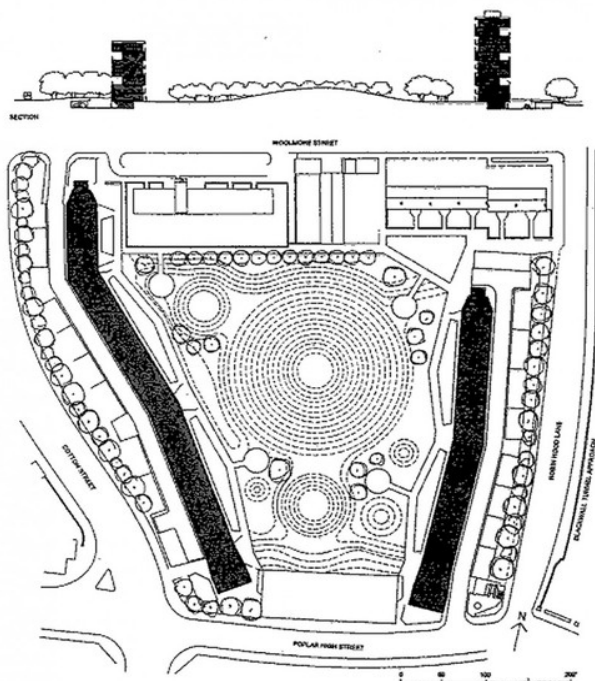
• Vista sul e planta de Robin Hood Gardens.
